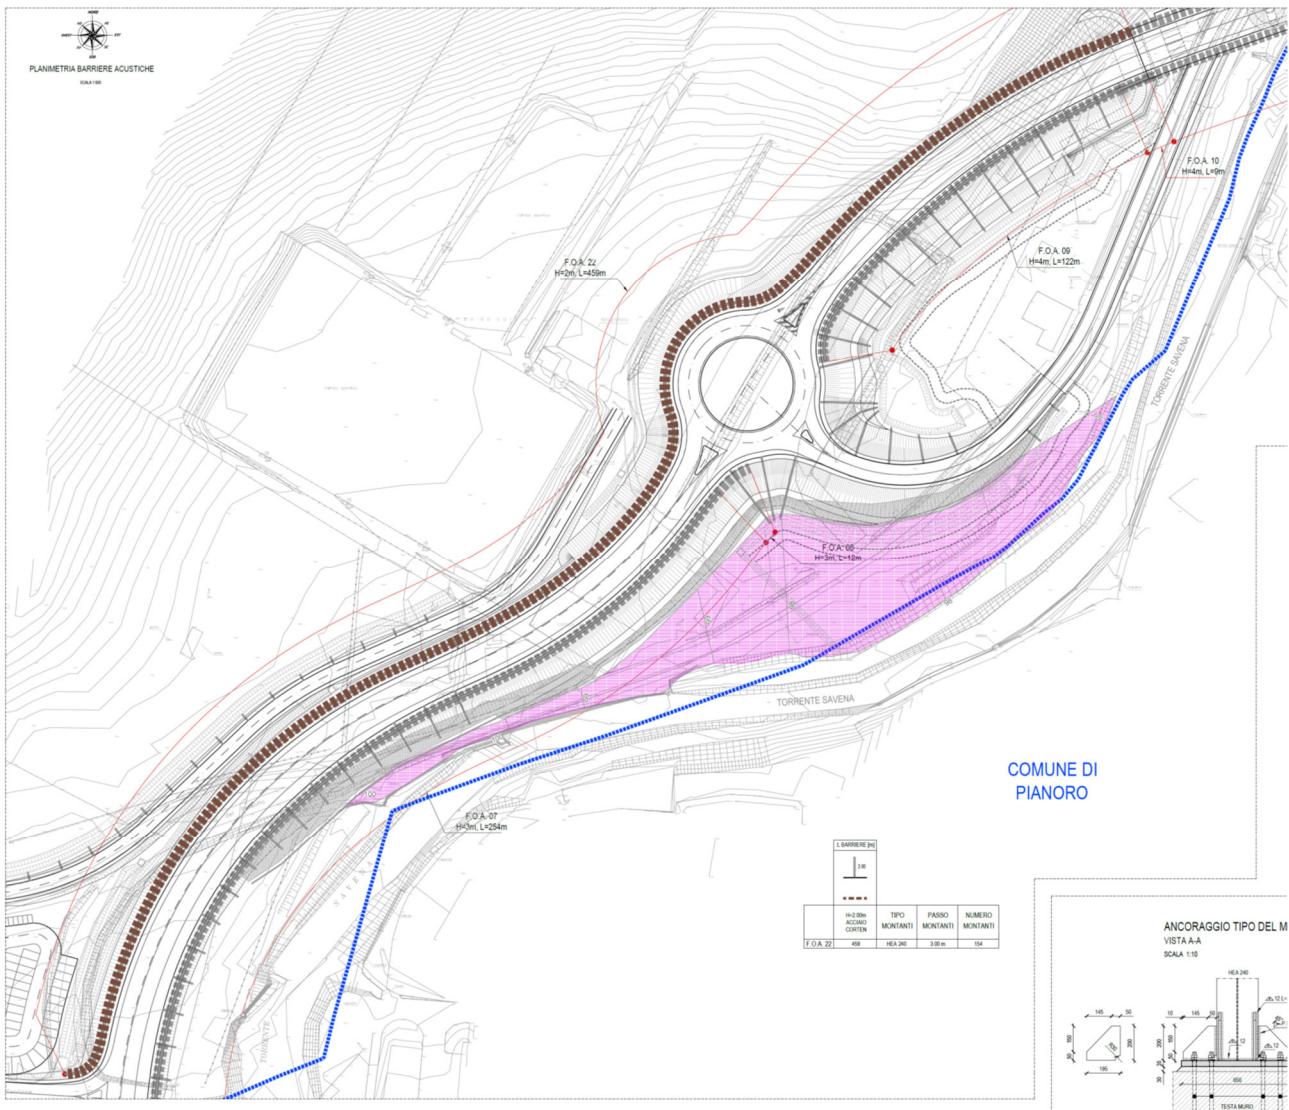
Individuazione planimetrica barriera FOA 22
